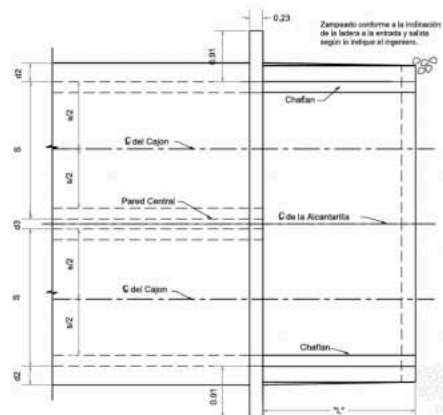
Anexo No. 22 – Detalles de Diseño de Cajones
